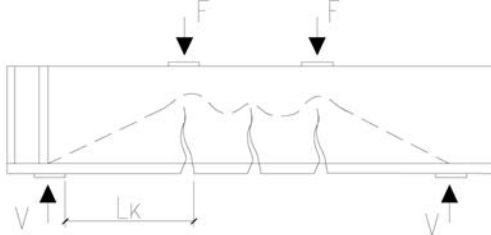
Схема роботи залізобетонної балки без зчеплення повздовжньої арматури з бетоном
